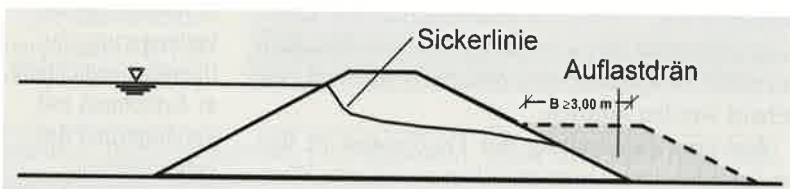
Deichquerschnitt mit Auflastdrän (Anschüttung).
